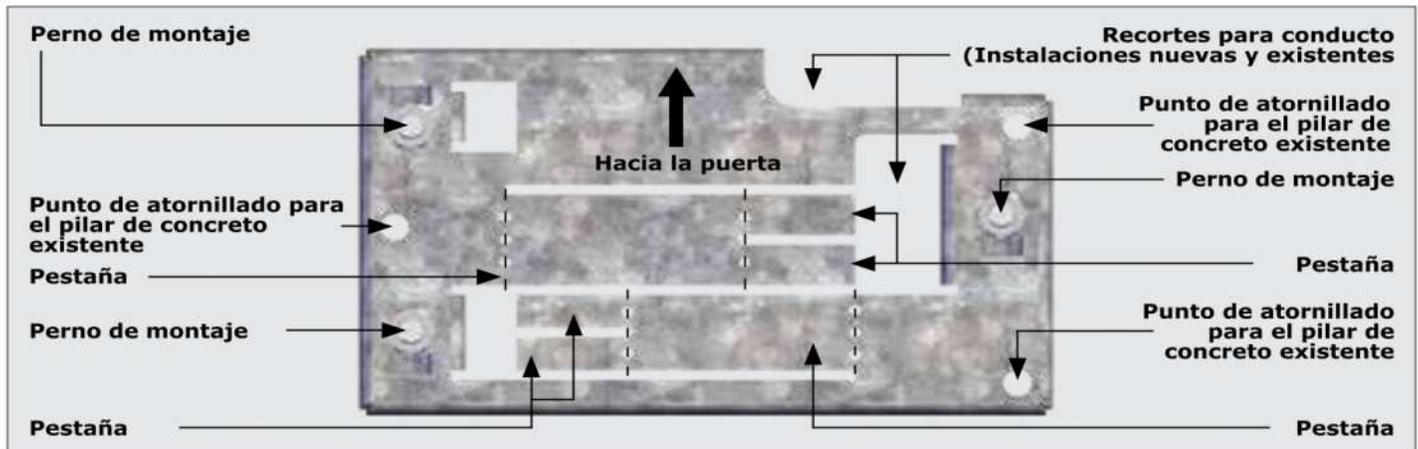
ENSAMBLE DE PLACA - VISTA SUPERIOR
